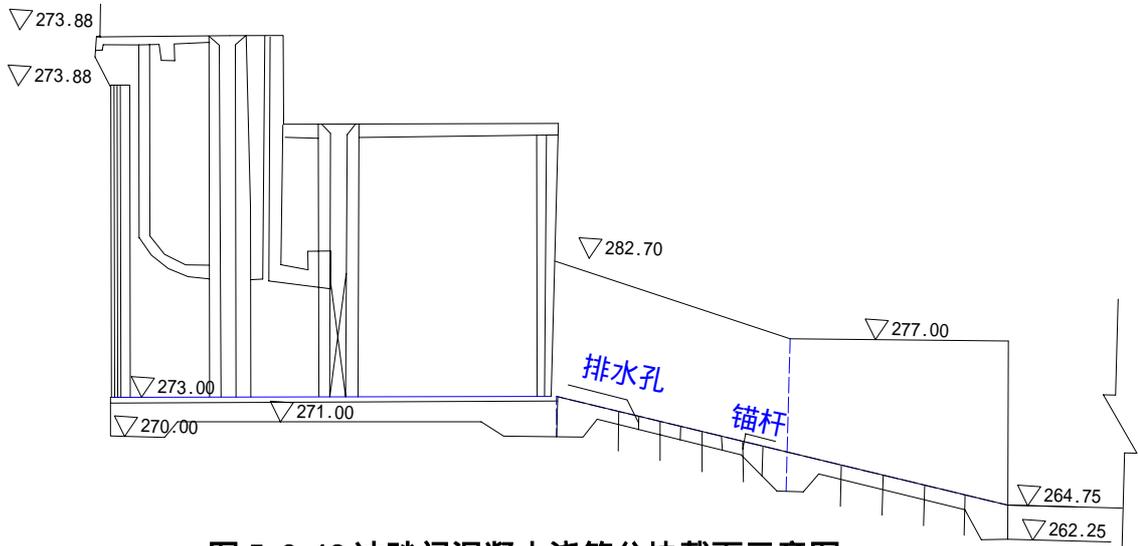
冲砂闸混凝土浇筑分块截面示意图
